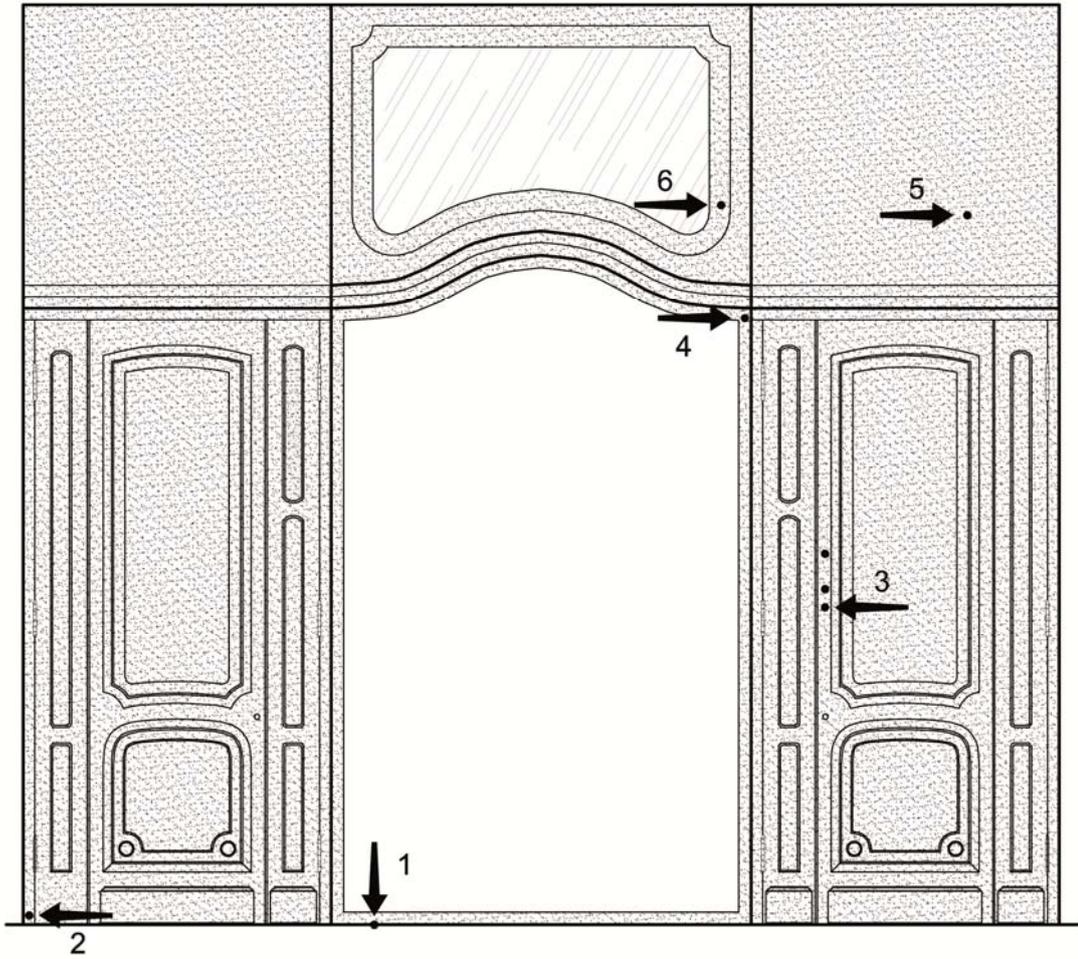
Схема отбора образцов. ЛК1. Развертка поверхности стен.
